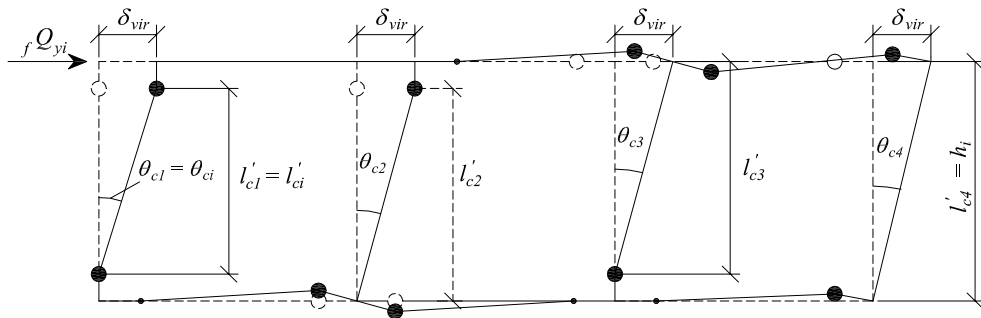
Planta aislada de un pórtico sometida al desplazamiento virtual δ_{vir}
